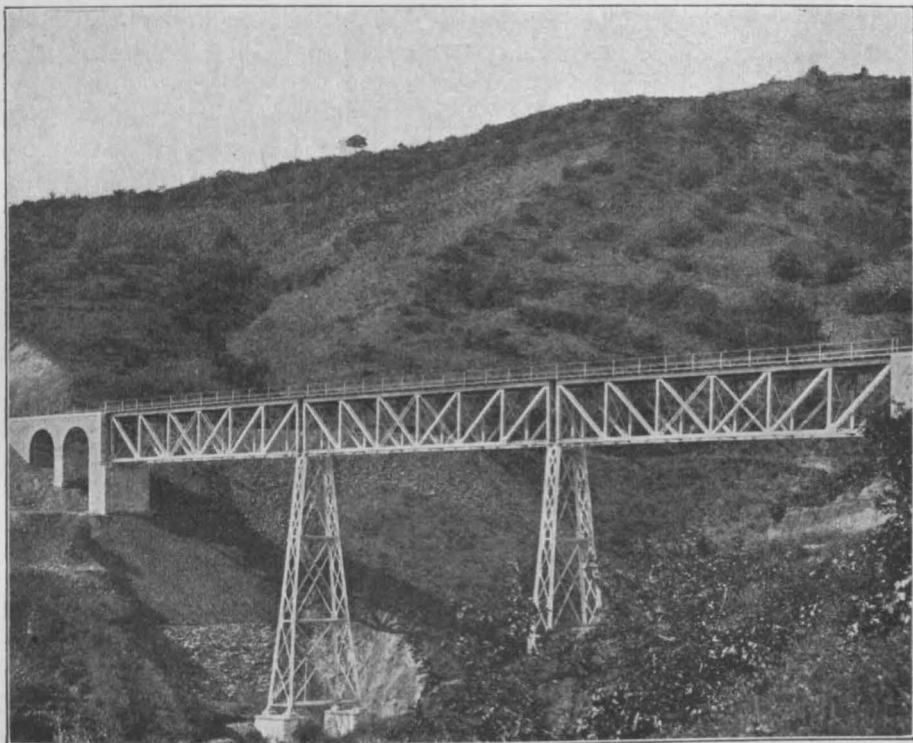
Yaila Talbrücke der Anatolischen Eisenbahn. 92 m lang. Gegenfachwerk.
